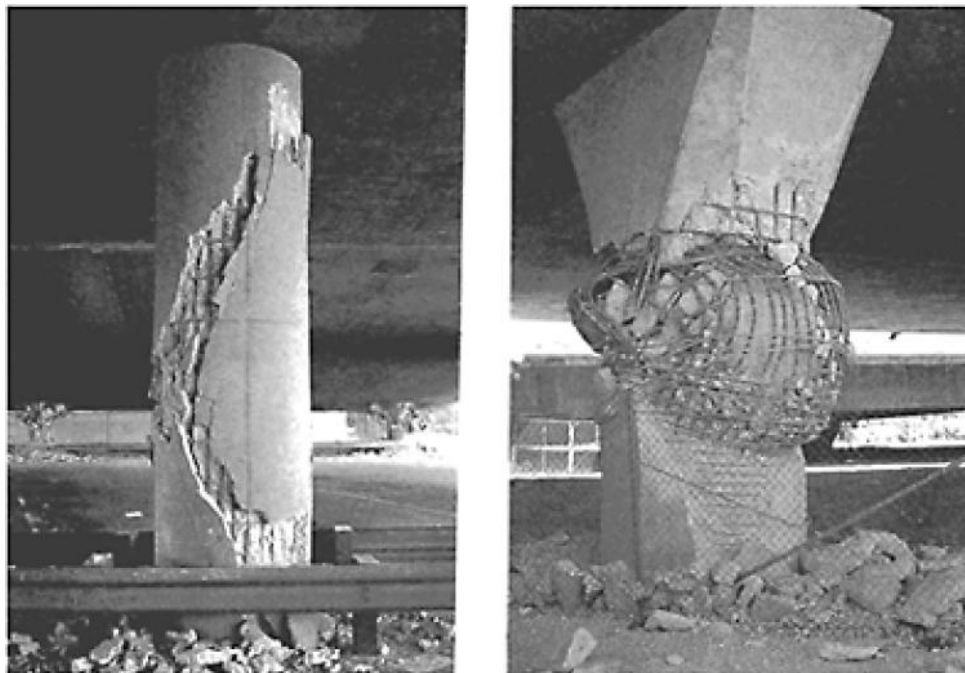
Falla por cizallamiento en columna, Terremoto de Northridge (1994)
